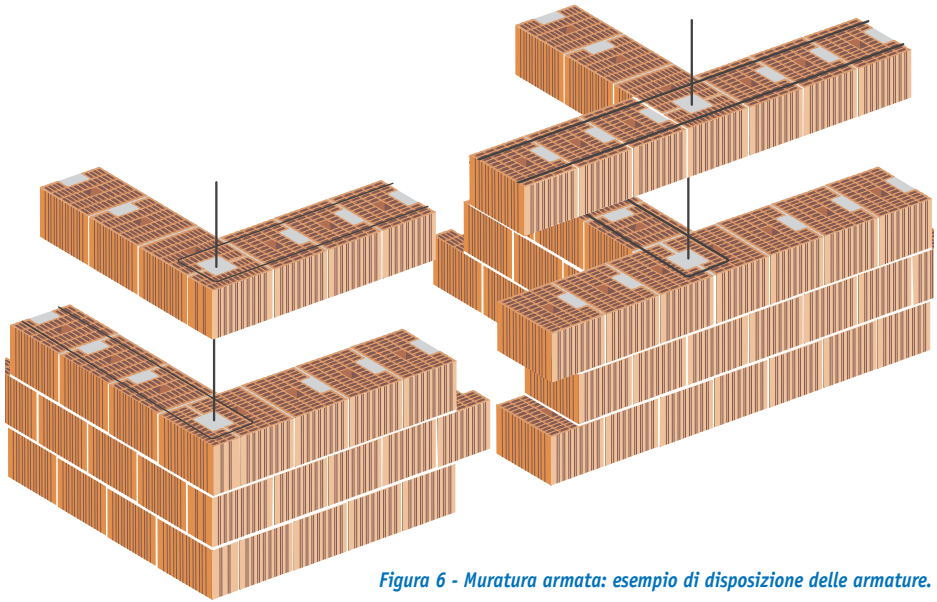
Muratura armata: esempio di disposizione delle armature.
